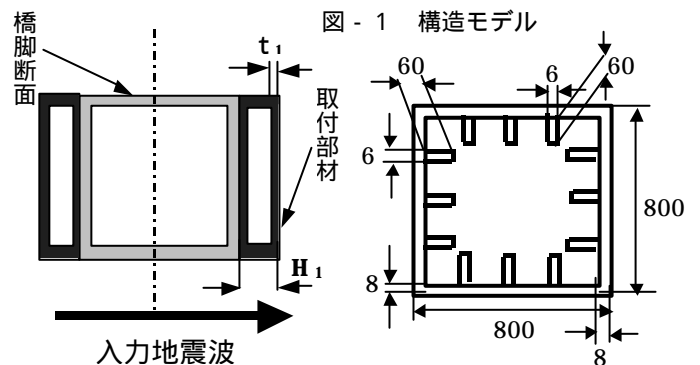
取付あり平面断面図 図-3 橋脚断面(単位mm)
